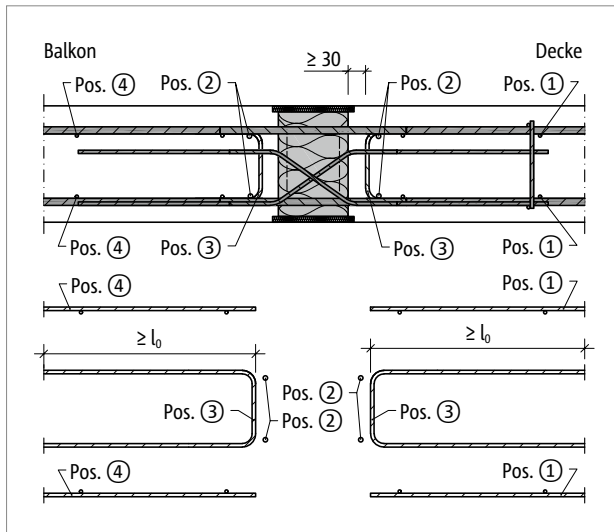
Schöck Isokorb® XT Typ DP: Bauseitige Bewehrung
